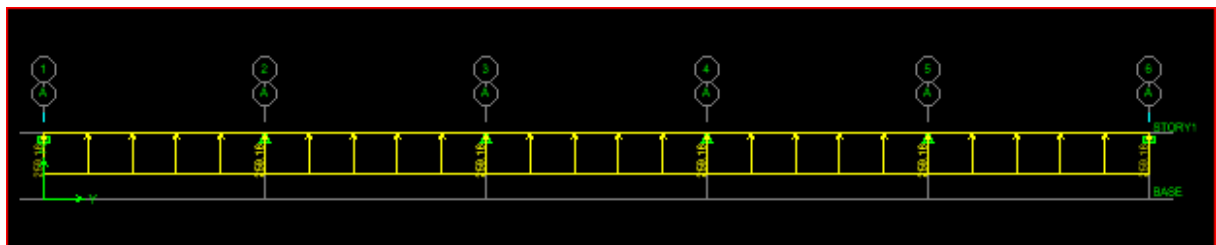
Schéma statique de la nervure ELU (sens transversal).
